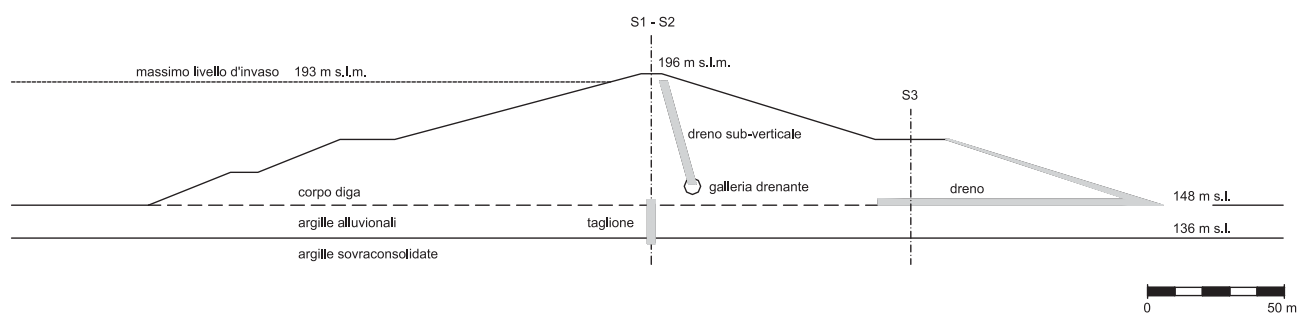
Sezione principale della diga Marana Capacciotti.
